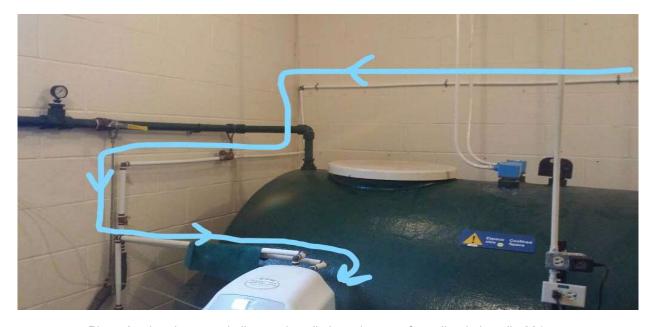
cheminement de l'eau et installations du poste frontalier de Lacolle 221
